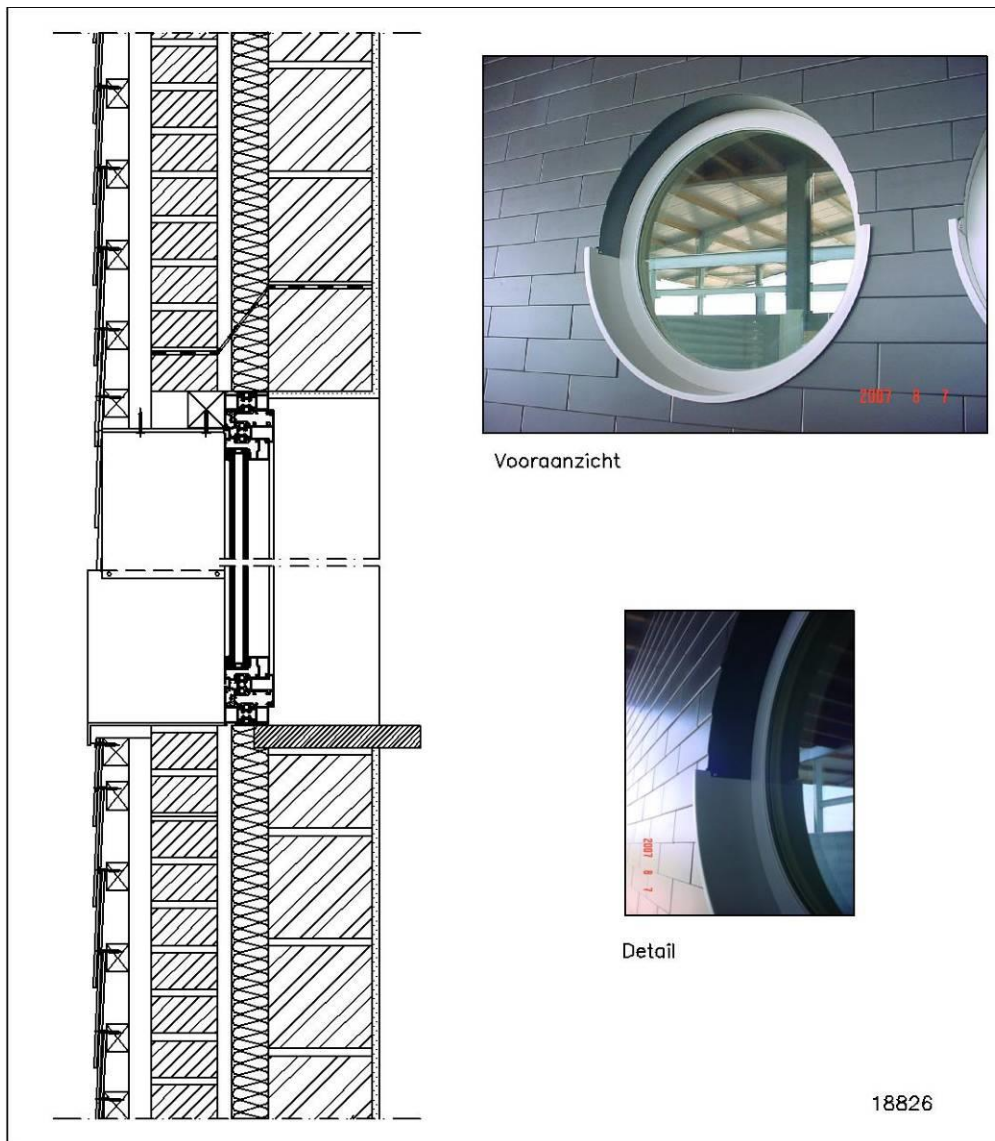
Voorbeeld inspringend rond raam – verticale doorsnede (foto's halfsteensverband)
